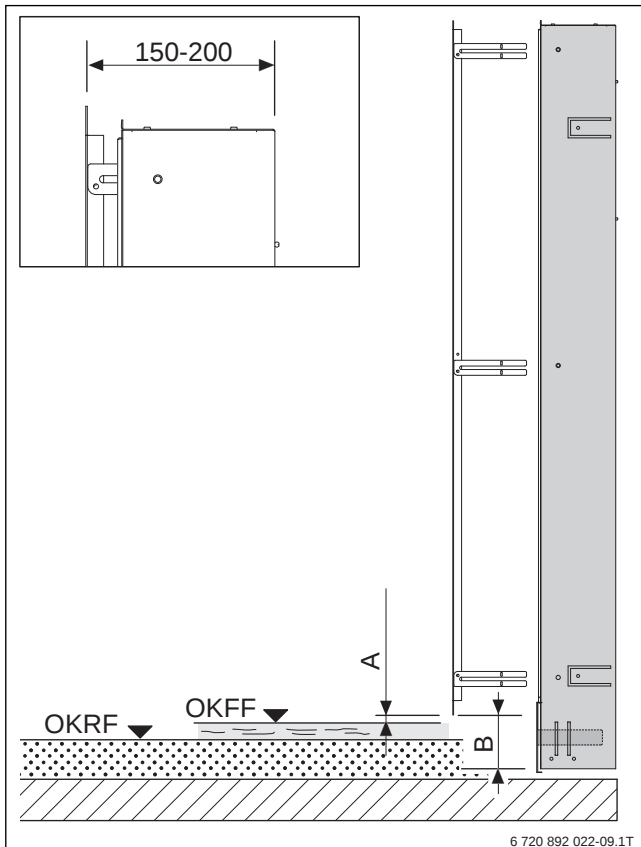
Mindesteinbaumaße Unterputzkasten (Maße in mm)
